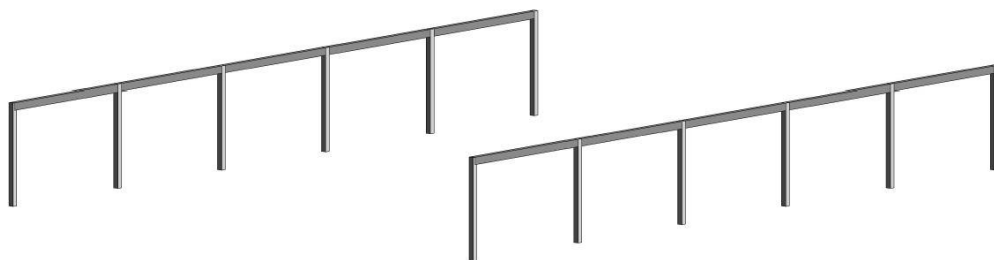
Proceso constructivo Fase 1 Fuente: Elaboración propia
